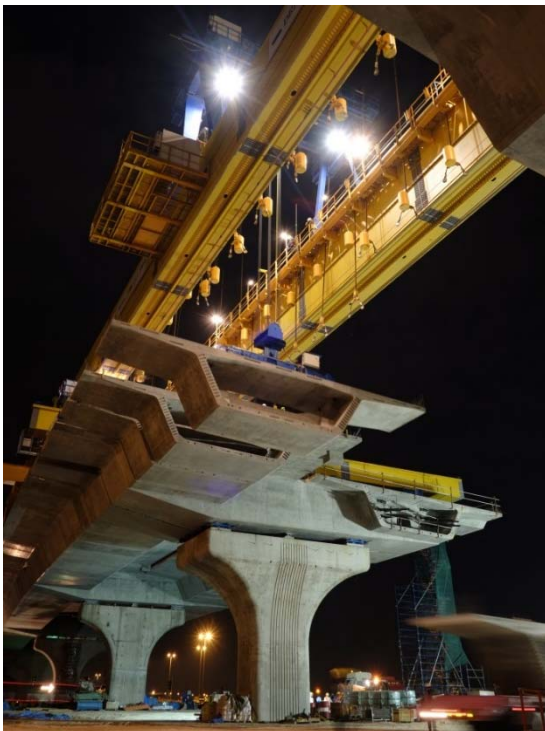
Detalle de unión de dovelas prefabricadas. Aplicación de resina epoxi.
